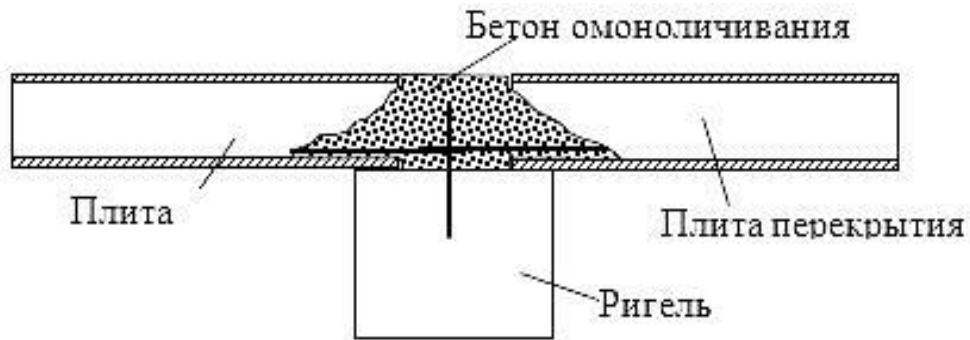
Поперечное сечение ригеля после омоноличивания участка между плитами бетоном
